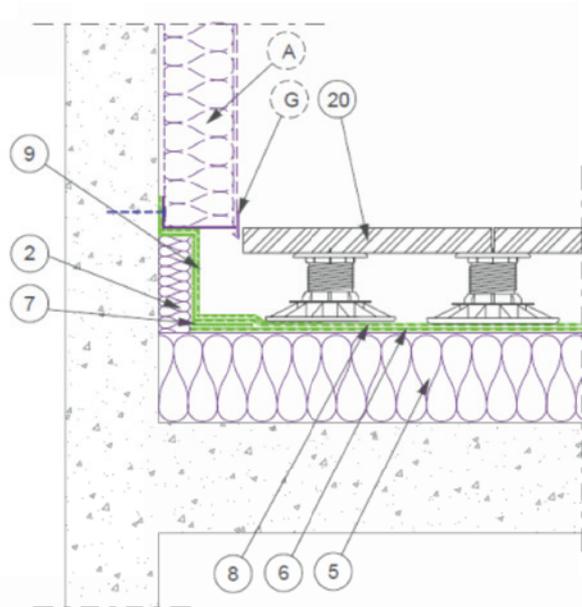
Relevé d'étanchéité sur isolant verre cellulaire apte à recevoir un revêtement d'étanchéité bitumineuse soudé - pied de façade isolée par l'extérieur
